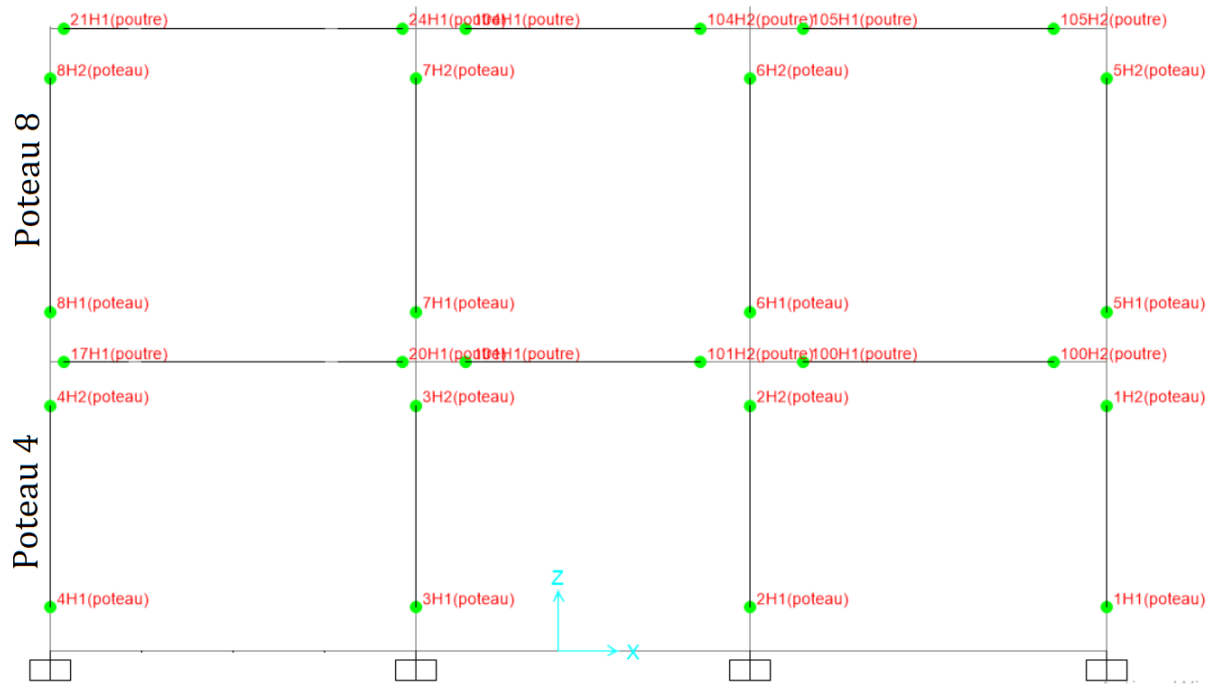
Hinge dans les poteaux et les poutres de l'ES et RDC
